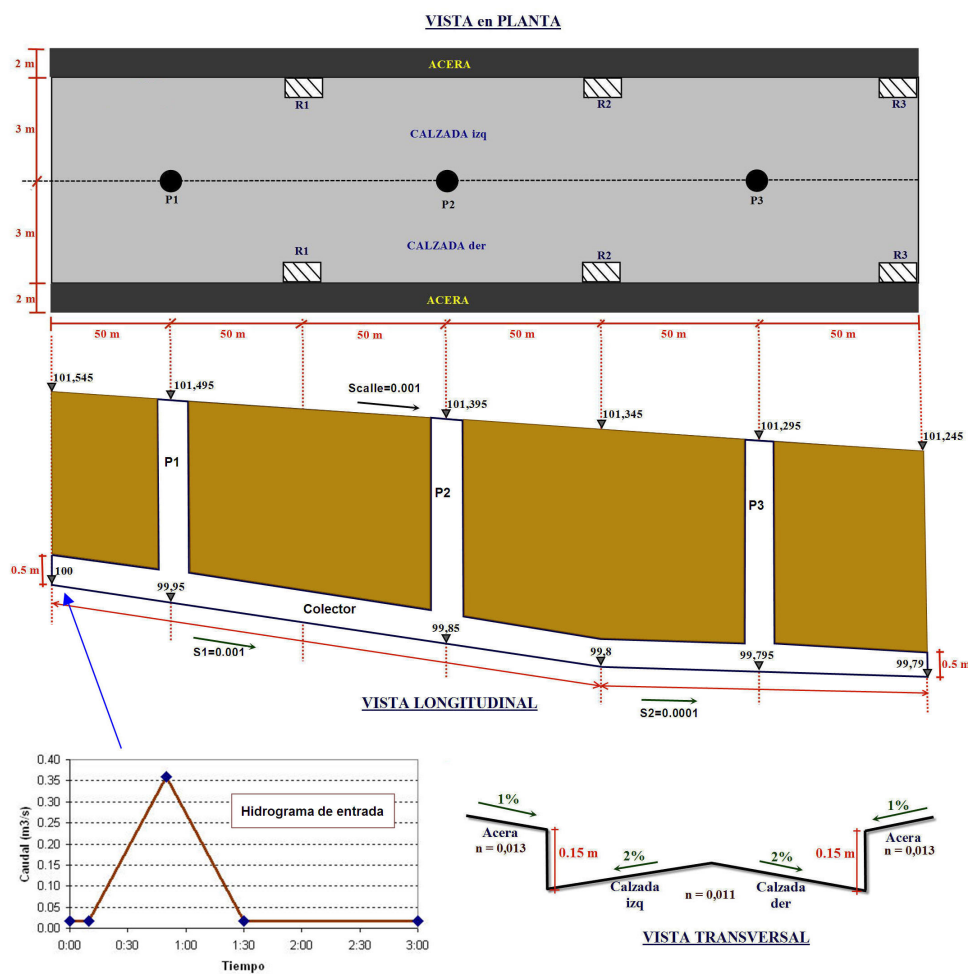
Vistas longitudinal, en planta y transversal del ejemplo a desarrollar
